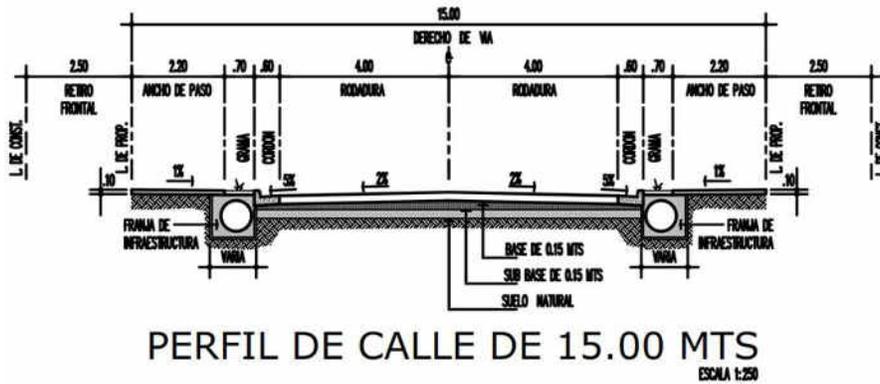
Plano esquemático del proyecto, entregado en el Estudio de Impacto Ambiental, “Movimiento de tierra, nivelación y calles de acceso”. Pagina 36.
